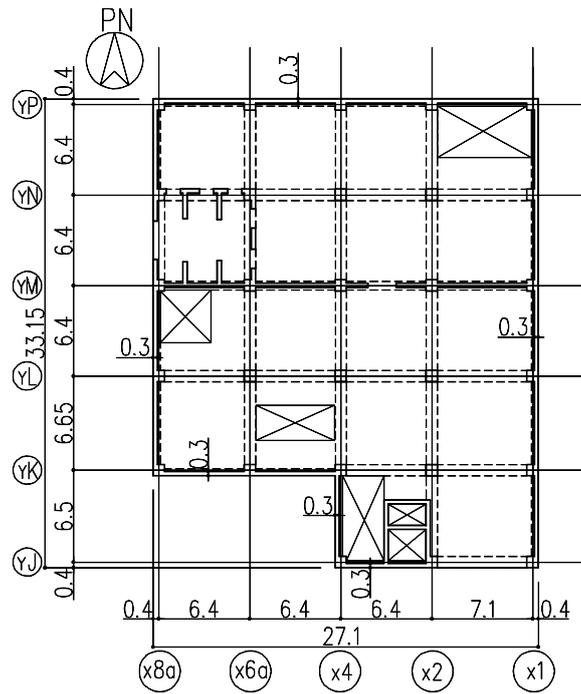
地上2階平面図 (G.L. +4.7) (单位 : m)
